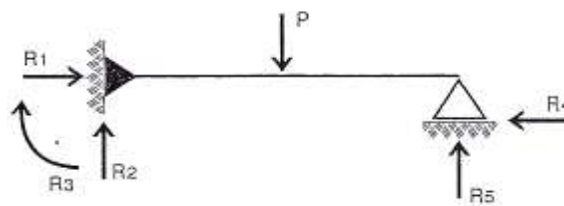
ESTRUCTURA HIPERESTÁTICA
